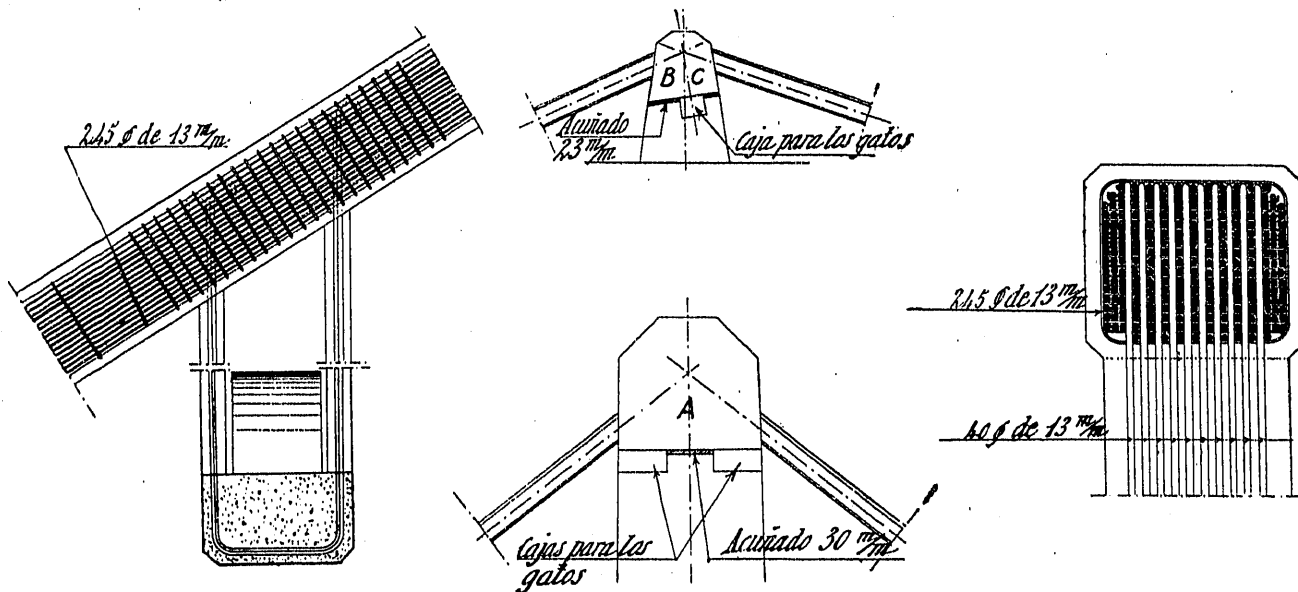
ª Detalles del enganche de las péndolas, cabezas de las pilas y armadura del arco
